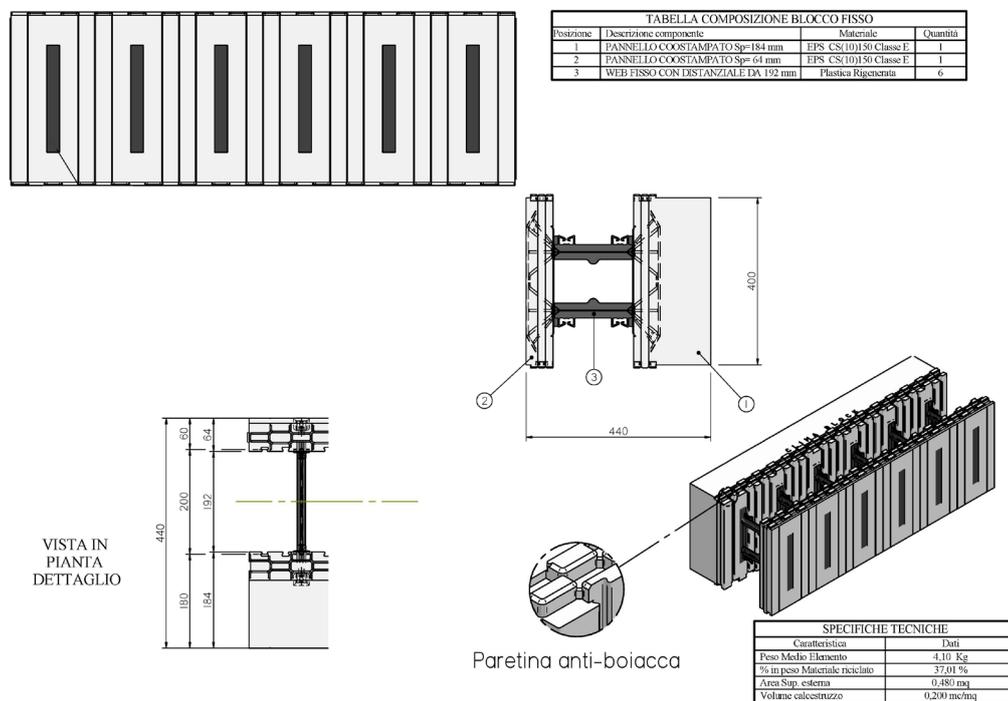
Schema raffigurativo blocco Clima blok. Fonte Pontarolo Engineering
